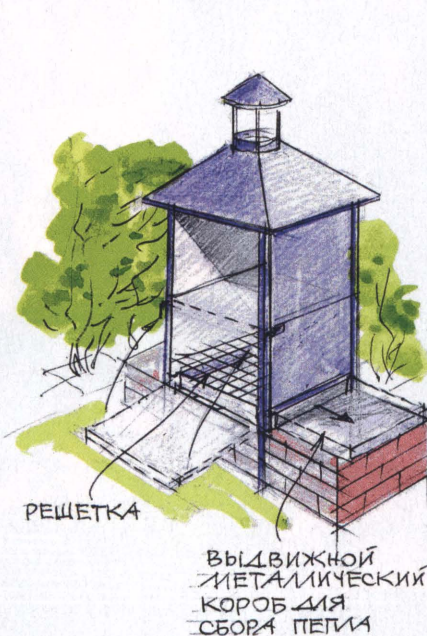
Каркас этой садовой печи сварен из стальных уголков, стенки — из металла и асбоцементных листов.
